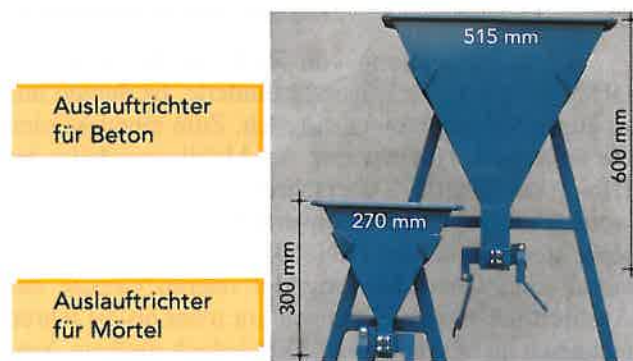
V-Funnel-Test – Auslauftrichter für Mörtel und Beton
